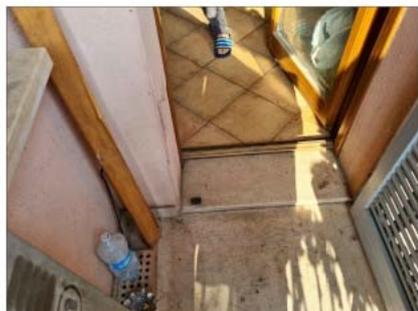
DETTAGLIO ALLOGGIO E BALCONE
